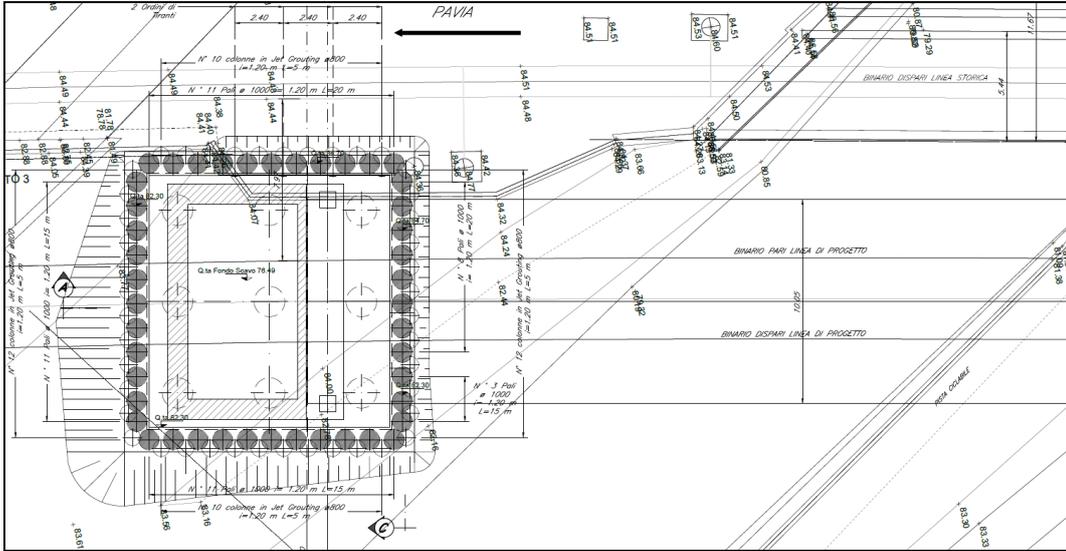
Spalla lato Pavia. Particolare delle opere di sostegno propedeutiche alla realizzazione della spalla.
